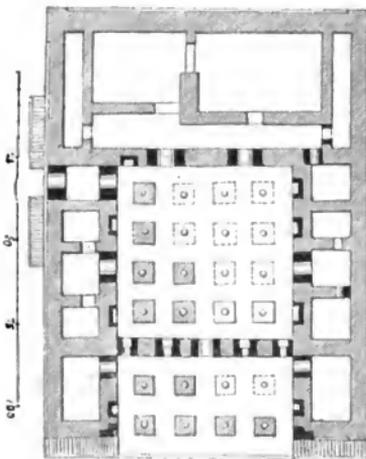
Grundriss des Dariuspalastes von Persepolis.
